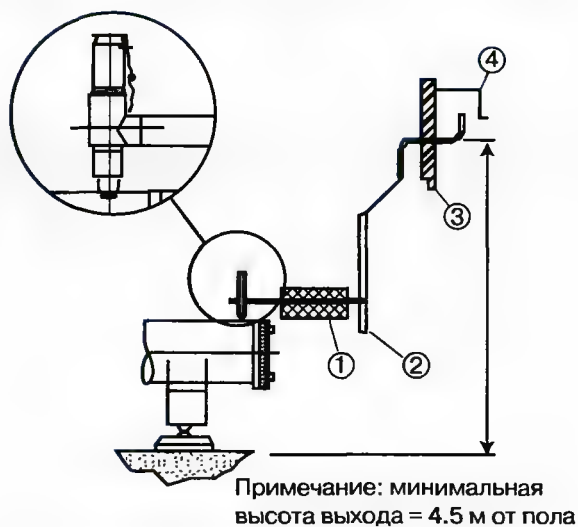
Схема прокладки сбросного трубопровода от предохранительного клапана холодильного контура чиллера:
